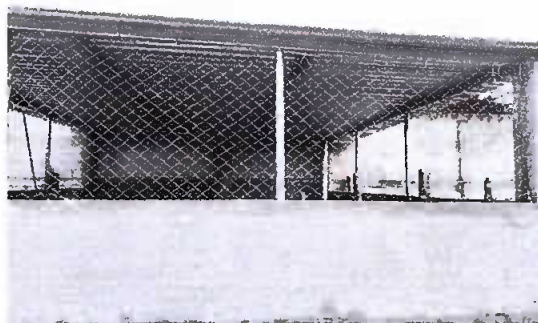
Reparación de muro perimetral de block con tubo hg y malla galvanizada, soleras intermedias
